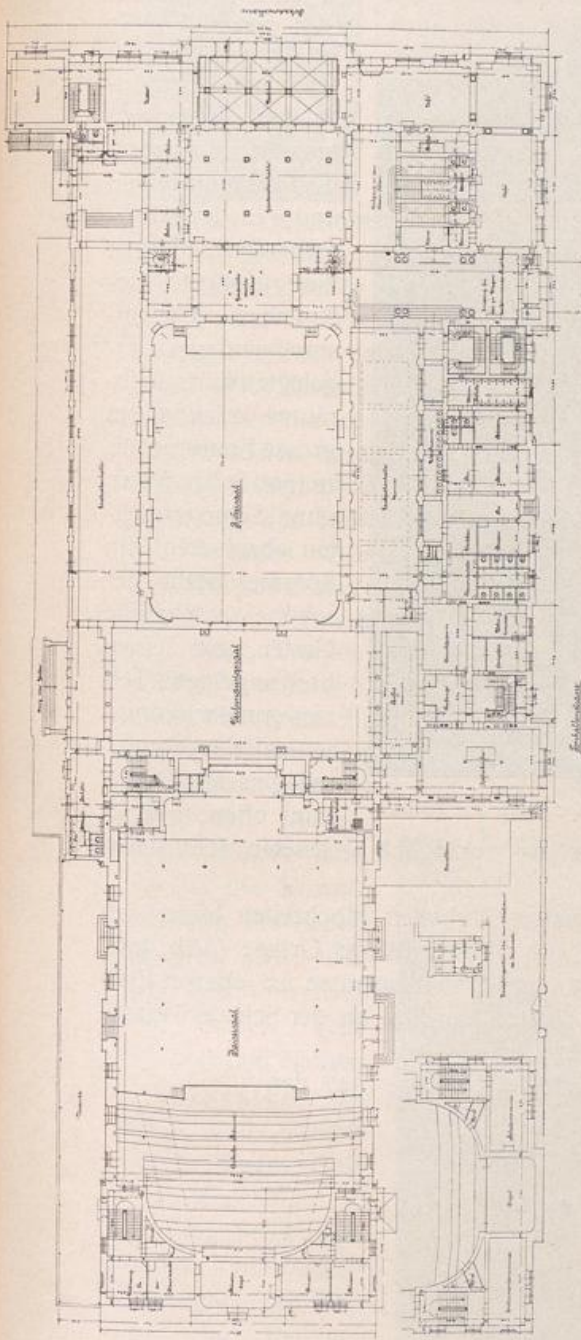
Erdgeschoss der Tonhalle. 1:735.
